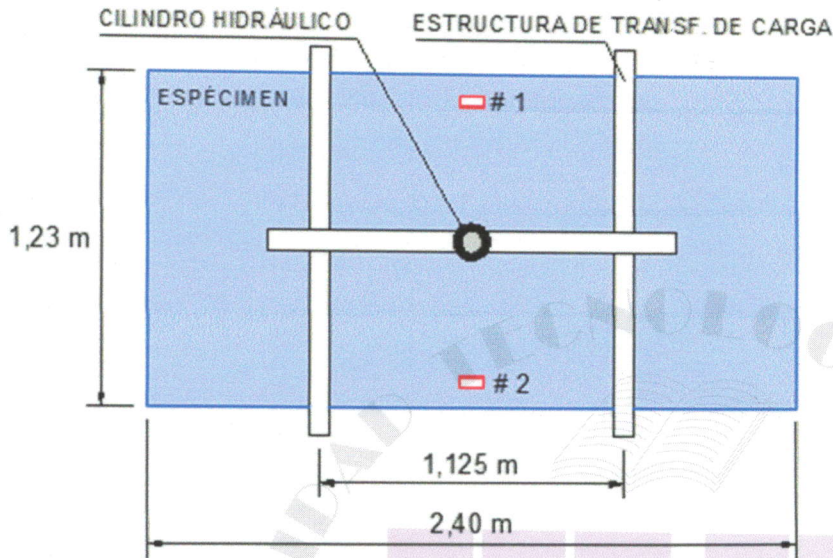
Esquema de la vista en planta del sistema de instrumentación del ensayo a flexión (FLEX - 1,23 m).
